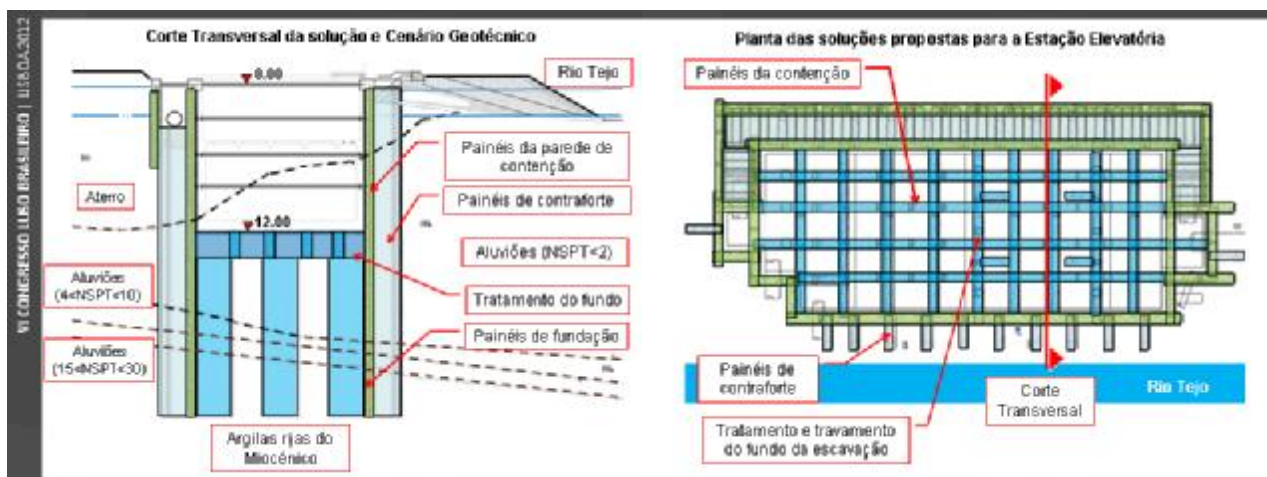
Secção transversal e planta das soluções adoptadas para a EE Agência.
